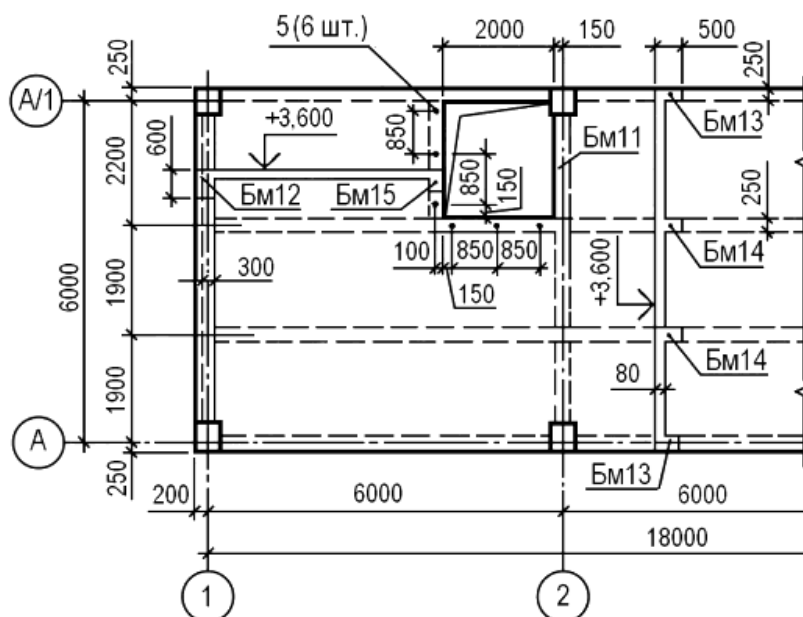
Схема расположения элементов монолитной железобетонной конструкции
